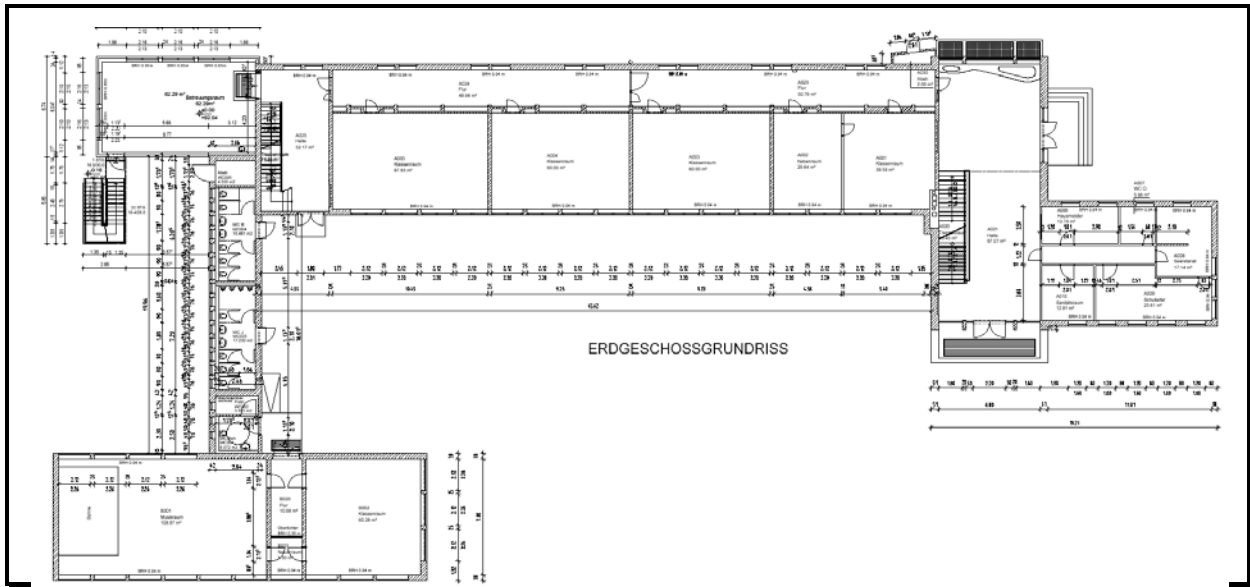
GS Am Clementinenhof: Grundriss Erdgeschoss Schulgebäude
